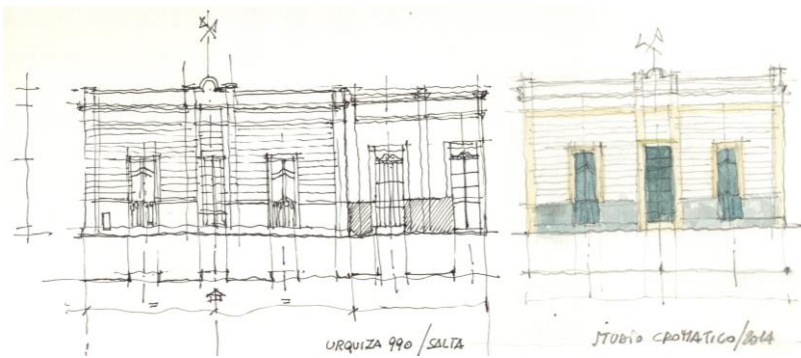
Casa chorizo. Av. 990. Salta. Relevamiento in situ
